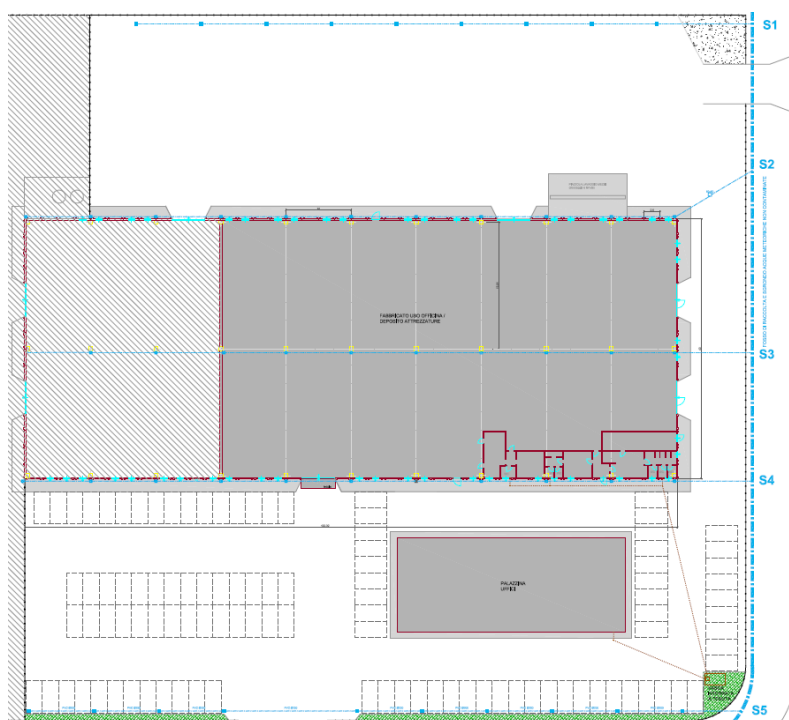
estratto tavola 3.1 – planimetria reti e scarichi stato di fatto
